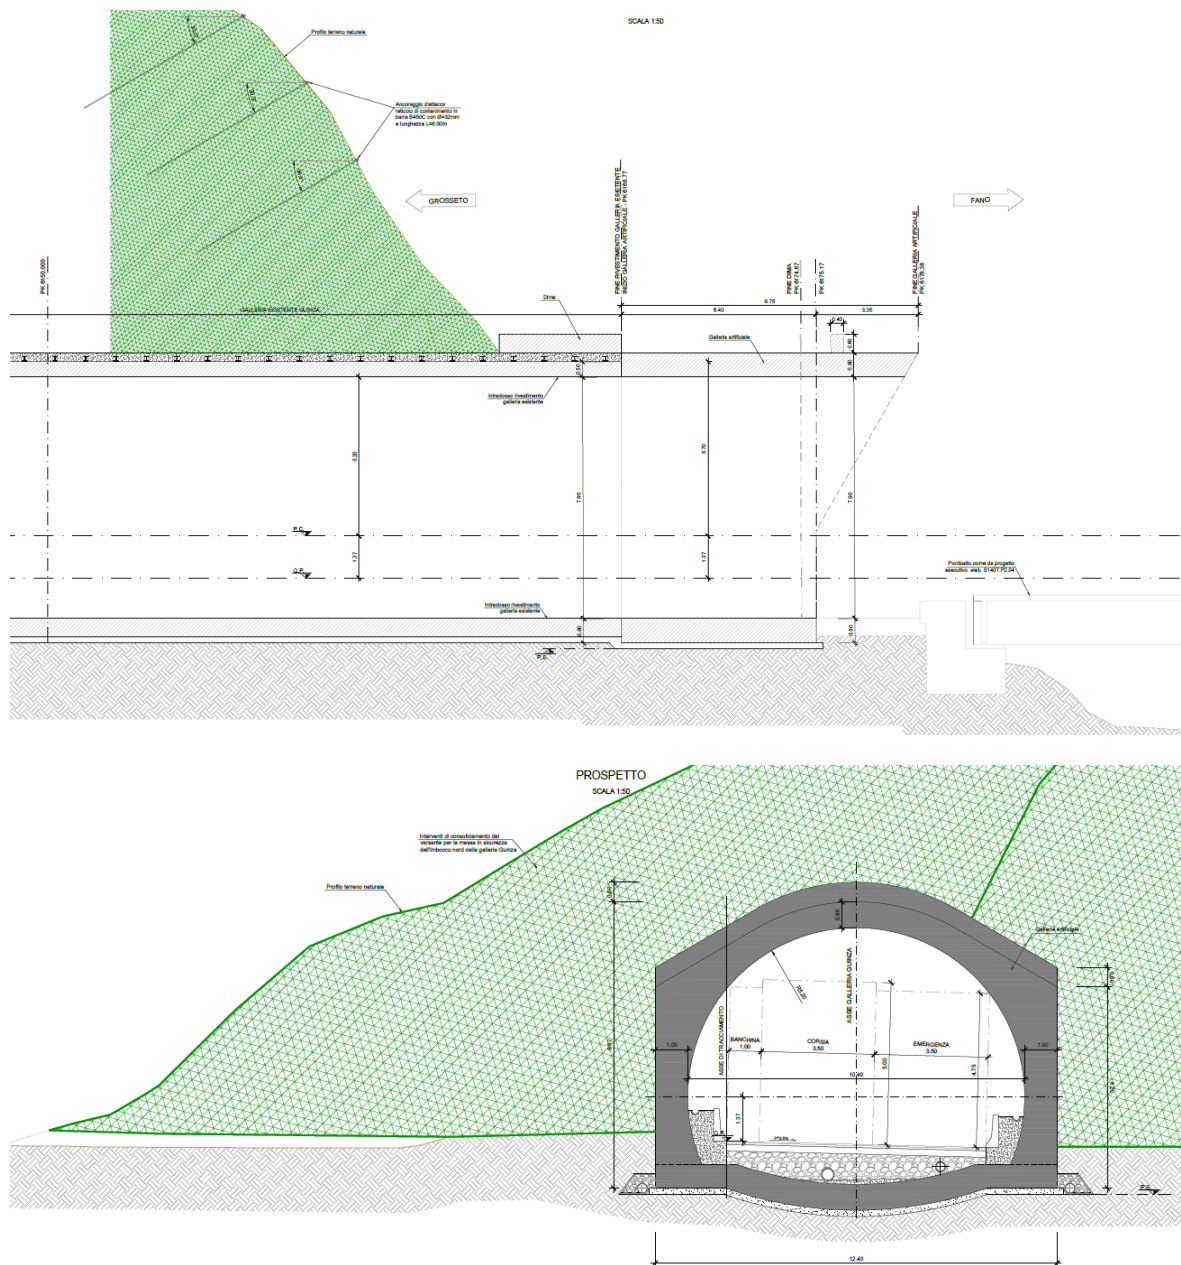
Galleria Guinza - Imbocco lato Marche – Sistemazione finale
